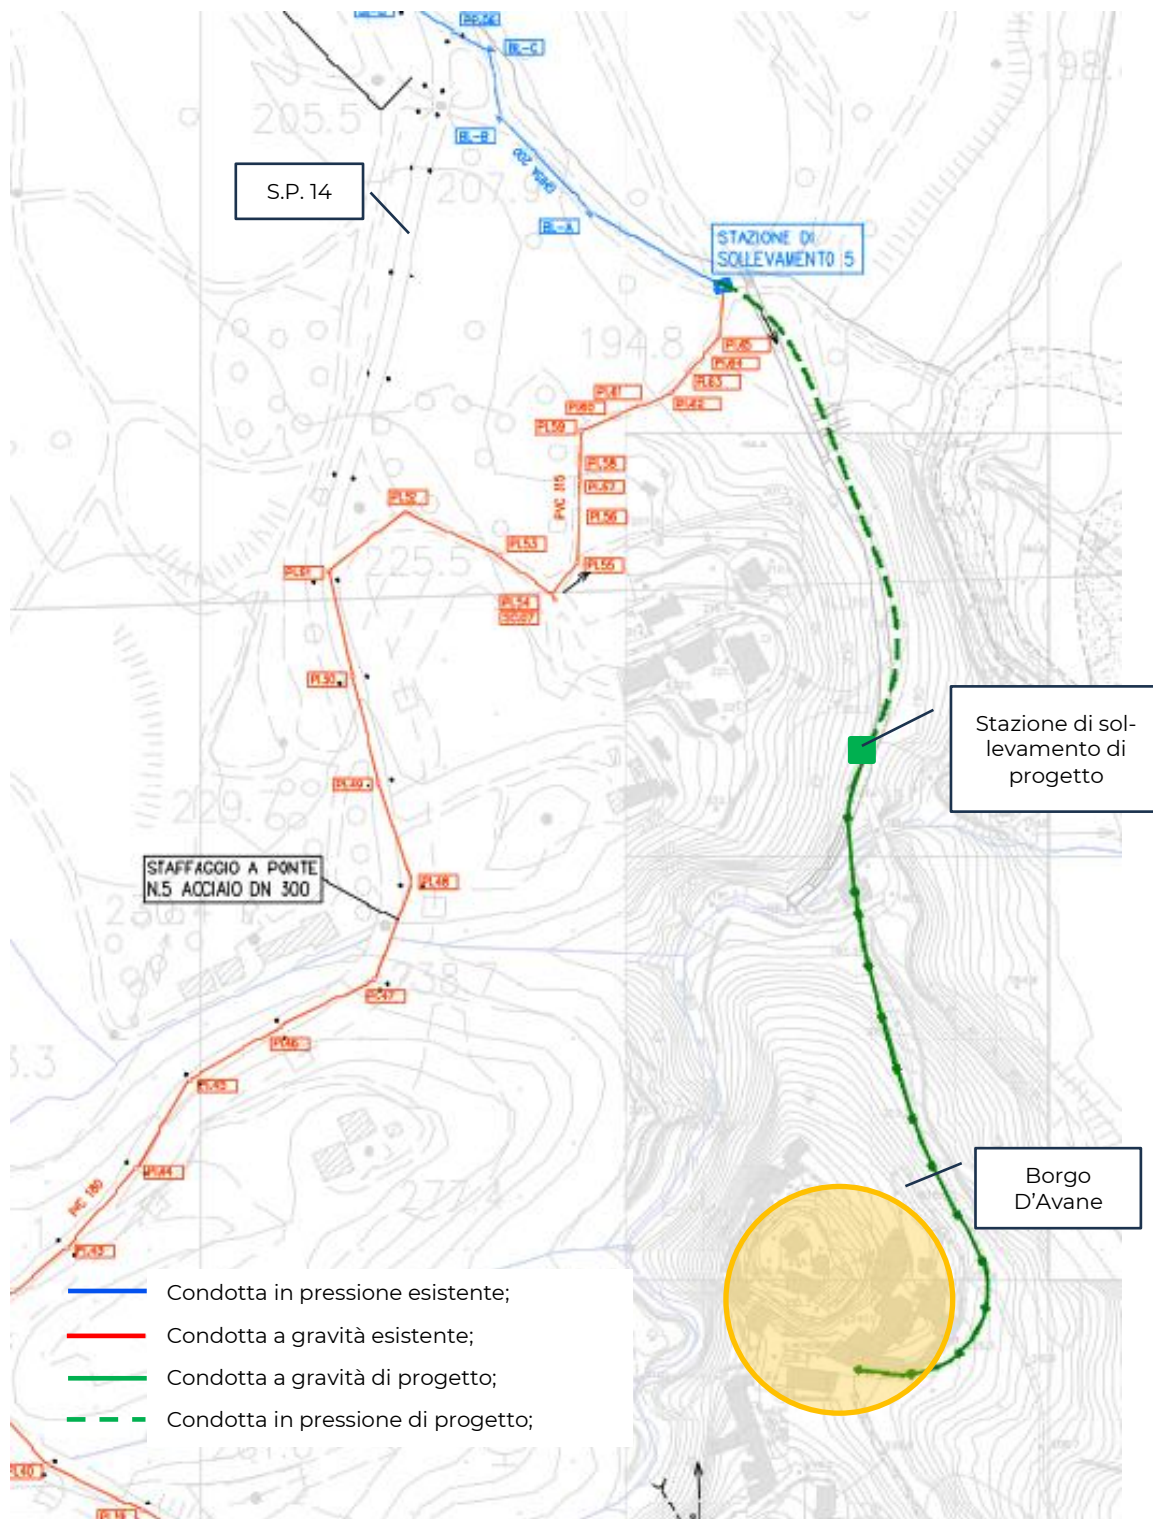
planimetria della rete fognaria esistente e di progetto.
